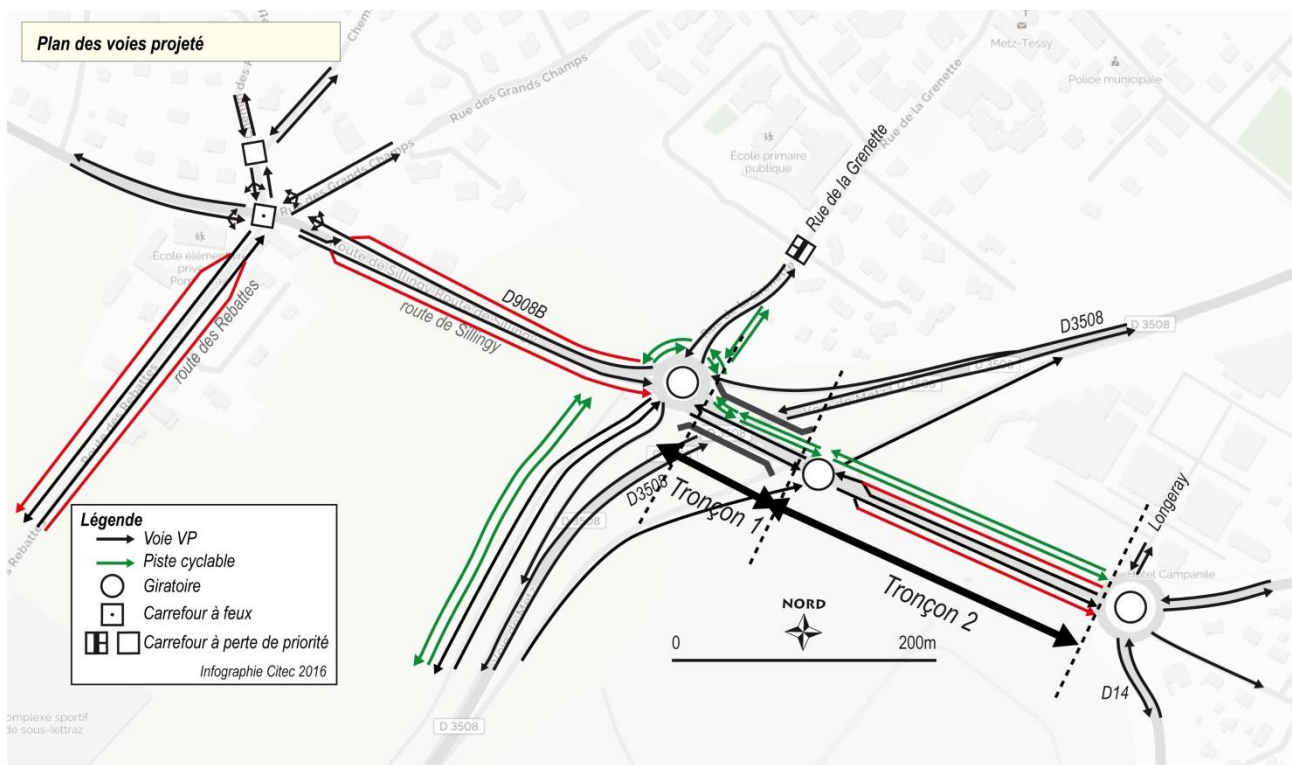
Plan des voies proposé - Secteur Grenette <-> Longerey
